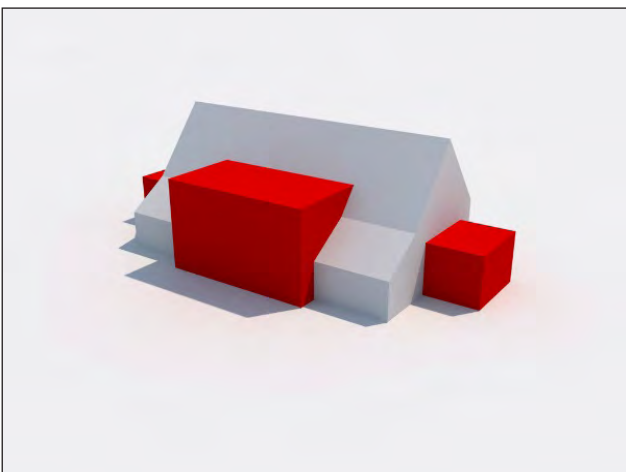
3D-Ansichten der möglichen Anbauten zum Haustyp C (Hausgruppe)
